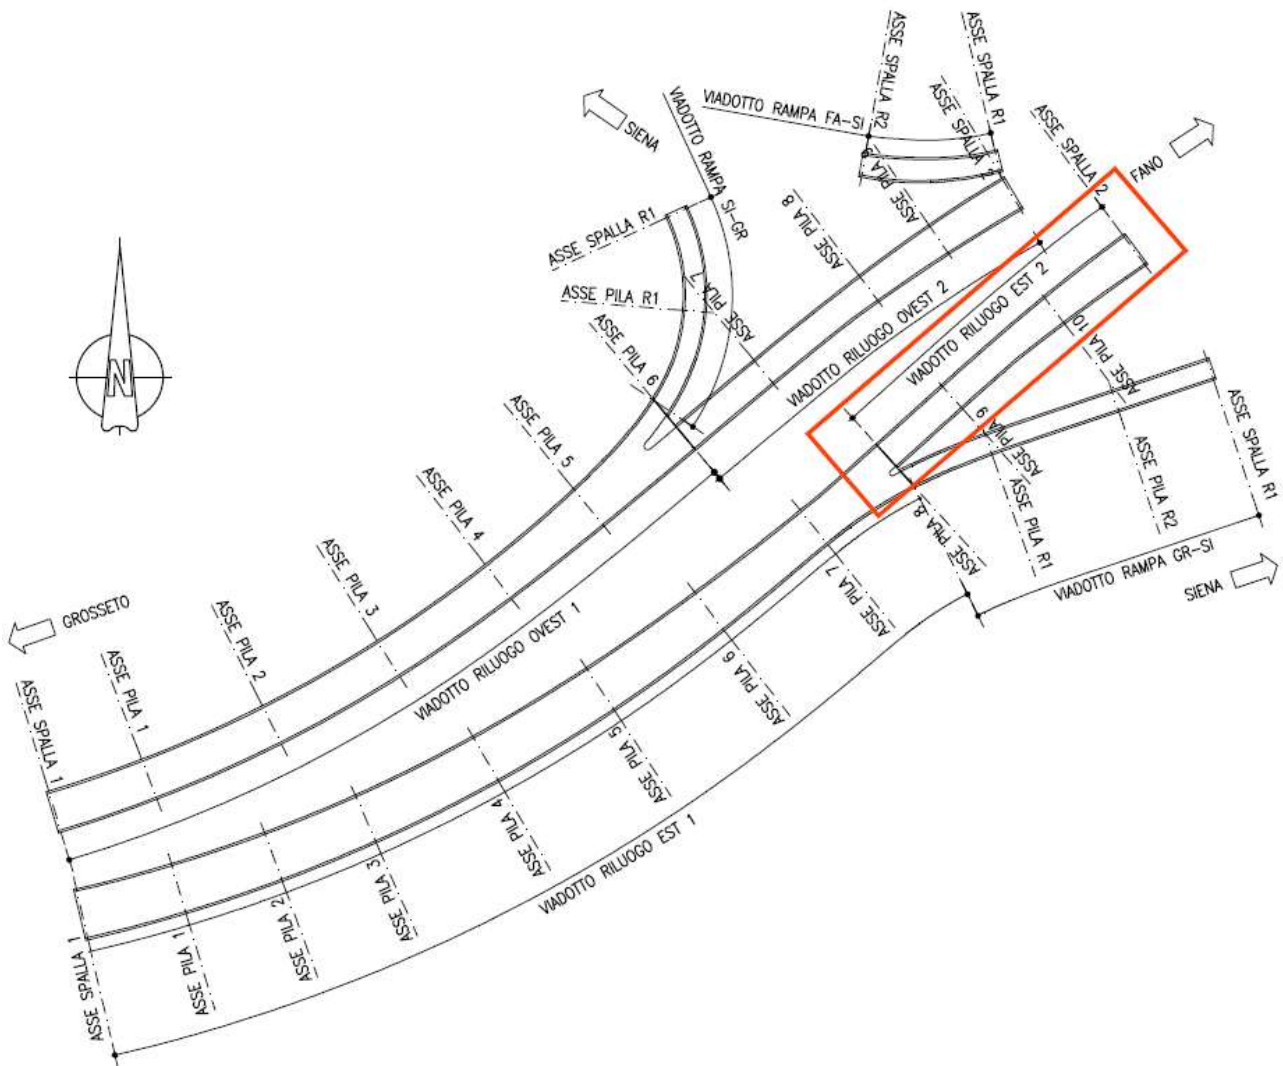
Planimetria generale dello Svincolo Ruffolo e ubicazione impalcato
